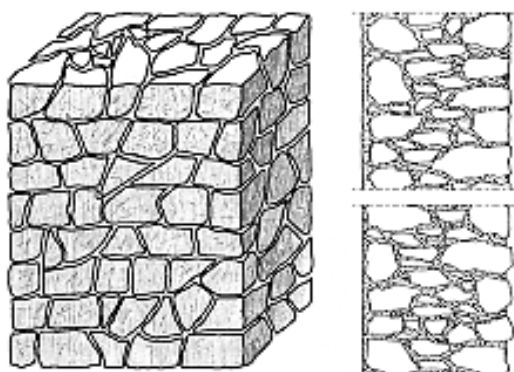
Muratura di pietrame con malta [Menditto G., 2013]
